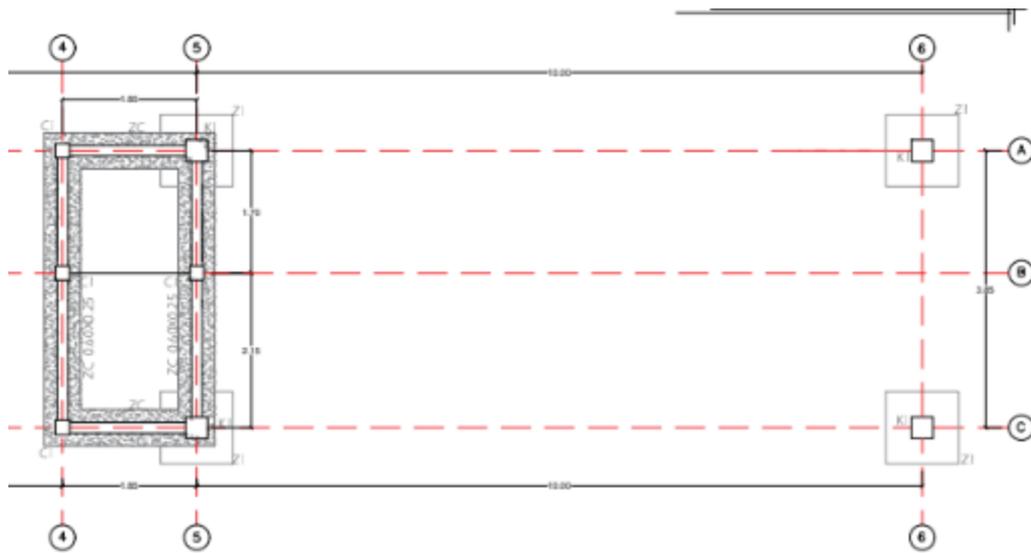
Columnas modificadas en Pórtico de Entrada
